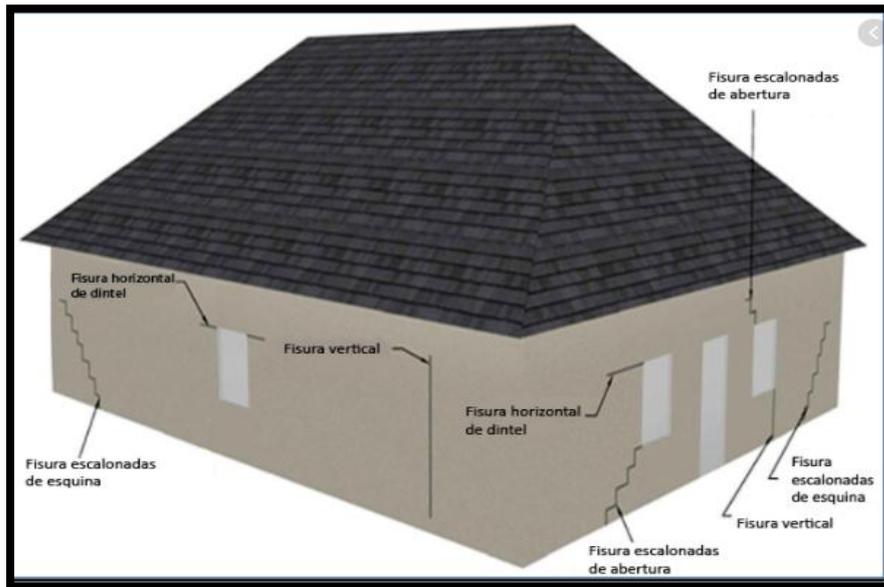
Fisura (Fuente: Bracken y Crawfo, 2019).
